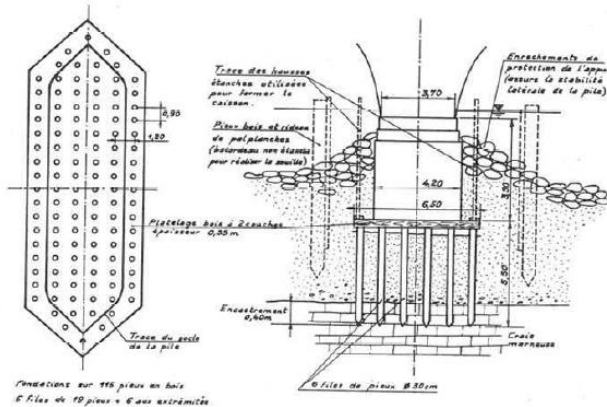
Exemple de fondation sur pieux bois, pont de Saumur
